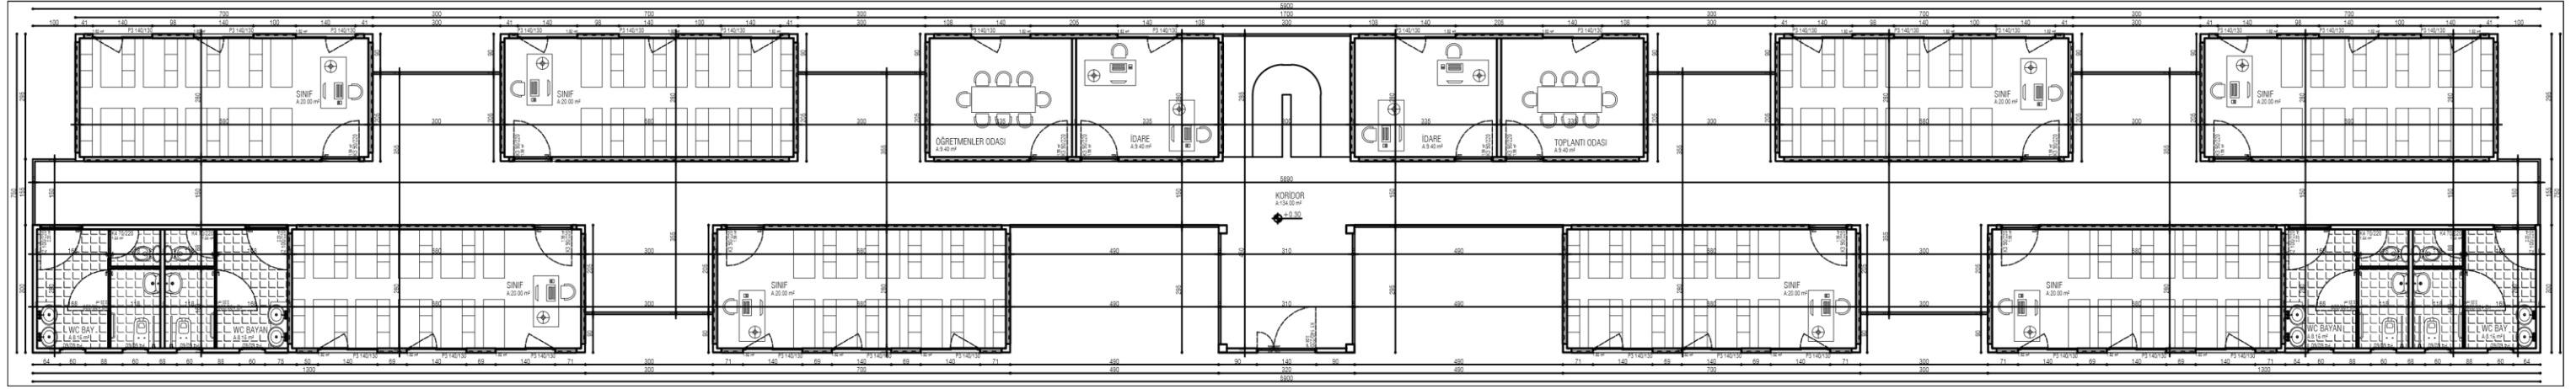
Anaokulu Kat Planları (Ölçek : 1/150).
